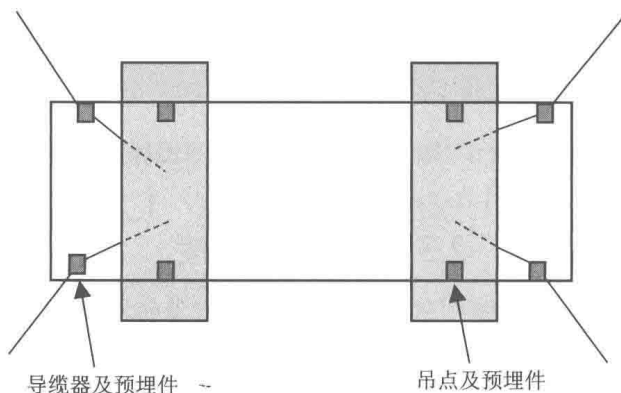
港珠澳大桥管节操控辅助舾装件平面布置示意
